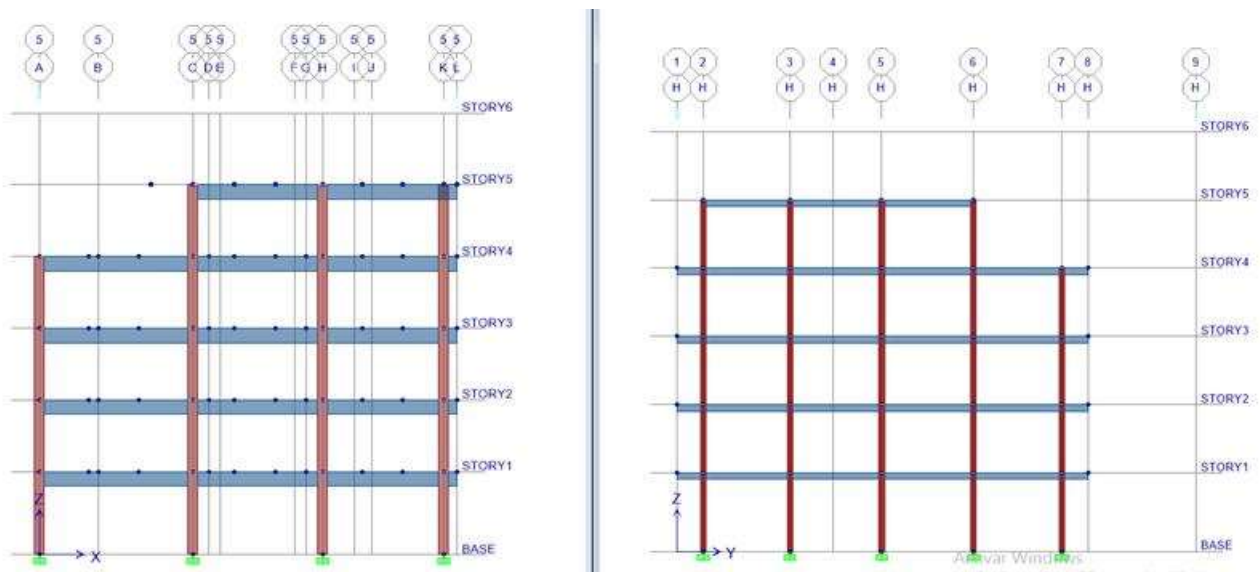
Esqueleto Estructural para el proyecto ETABS – Vistas Laterales
